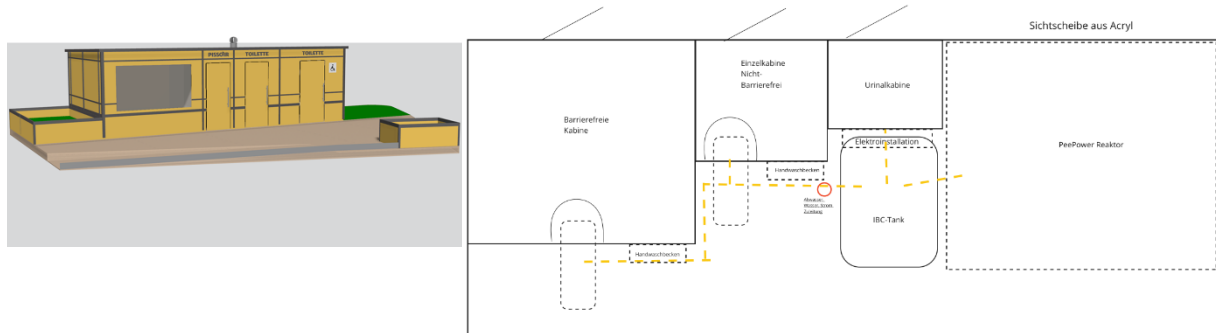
2: Außenansicht (Modell) und Grundriss des Toilettengebäudes
